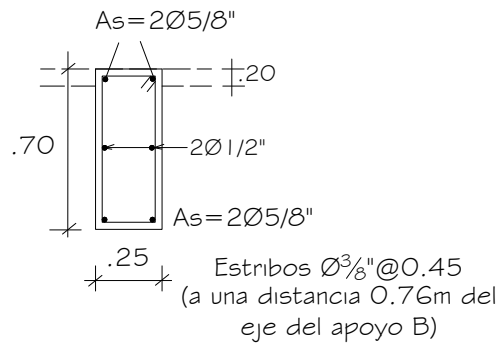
Armadura longitudinal y transversal en viga diafragma
